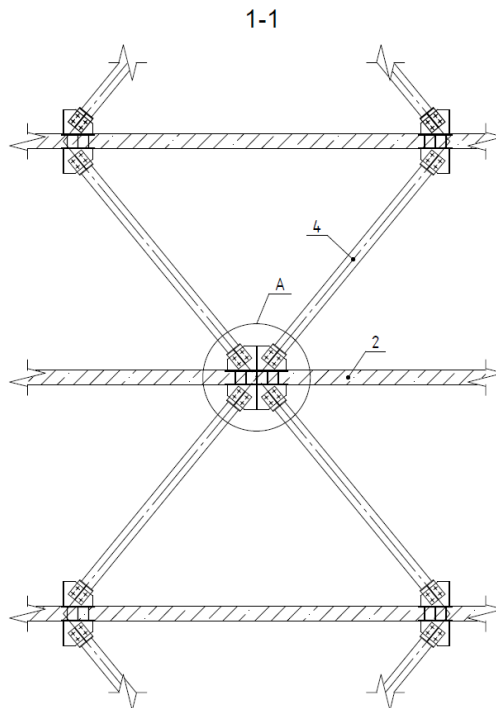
Вид на связи: 2 – плита перекрытия; 4 – элемент связи
